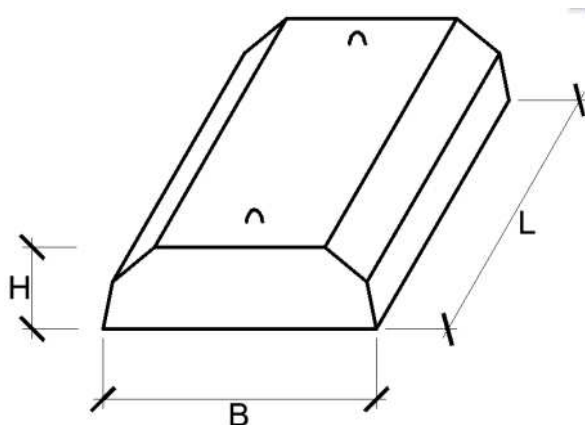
Плиты железобетонные ленточных фундаментов сплошные (тип 2)
